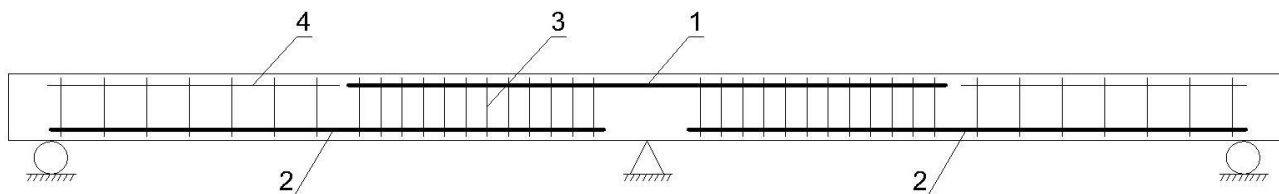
Схема армування нерозрізної залізобетонної монолітної балки:
